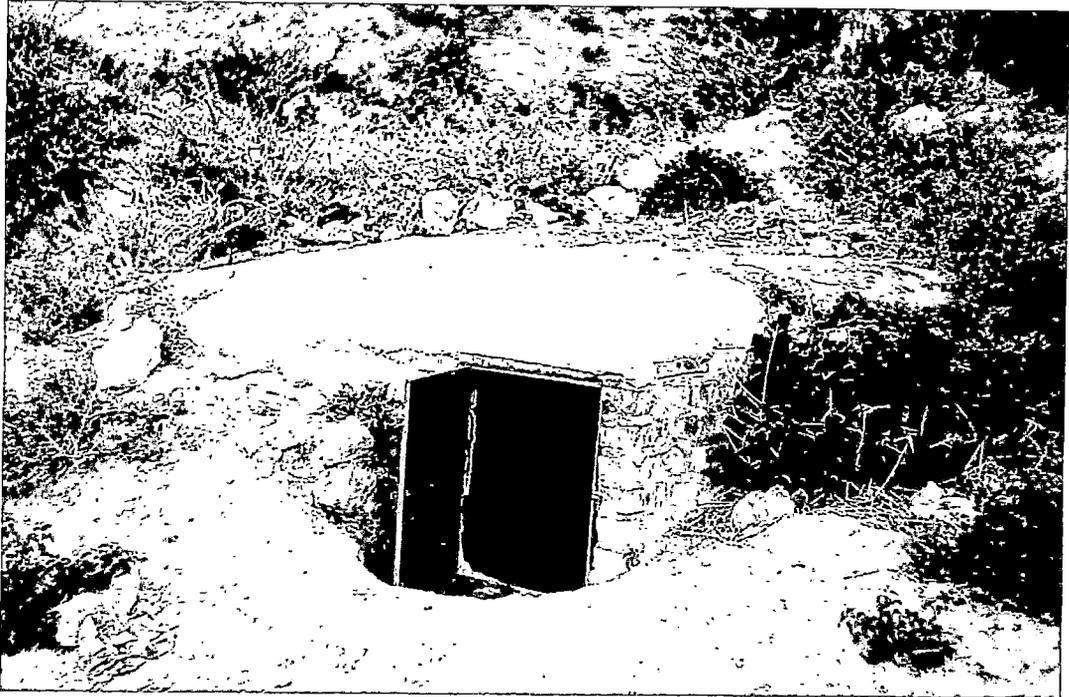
Acercamiento al puquial protegido con obras de concreto.
